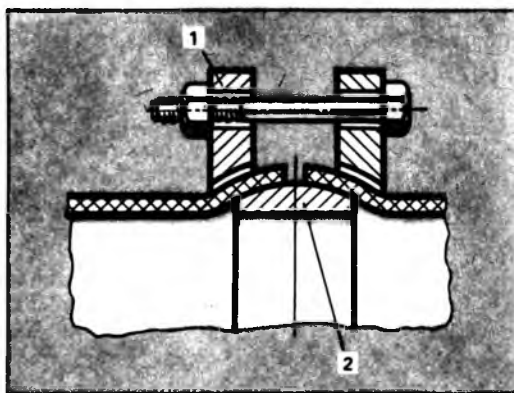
Разъемное соединение полиэтиленовых труб: 1 — фланец прижимной с внутренней конической частью, 2 — двуконусная металлическая втулка
